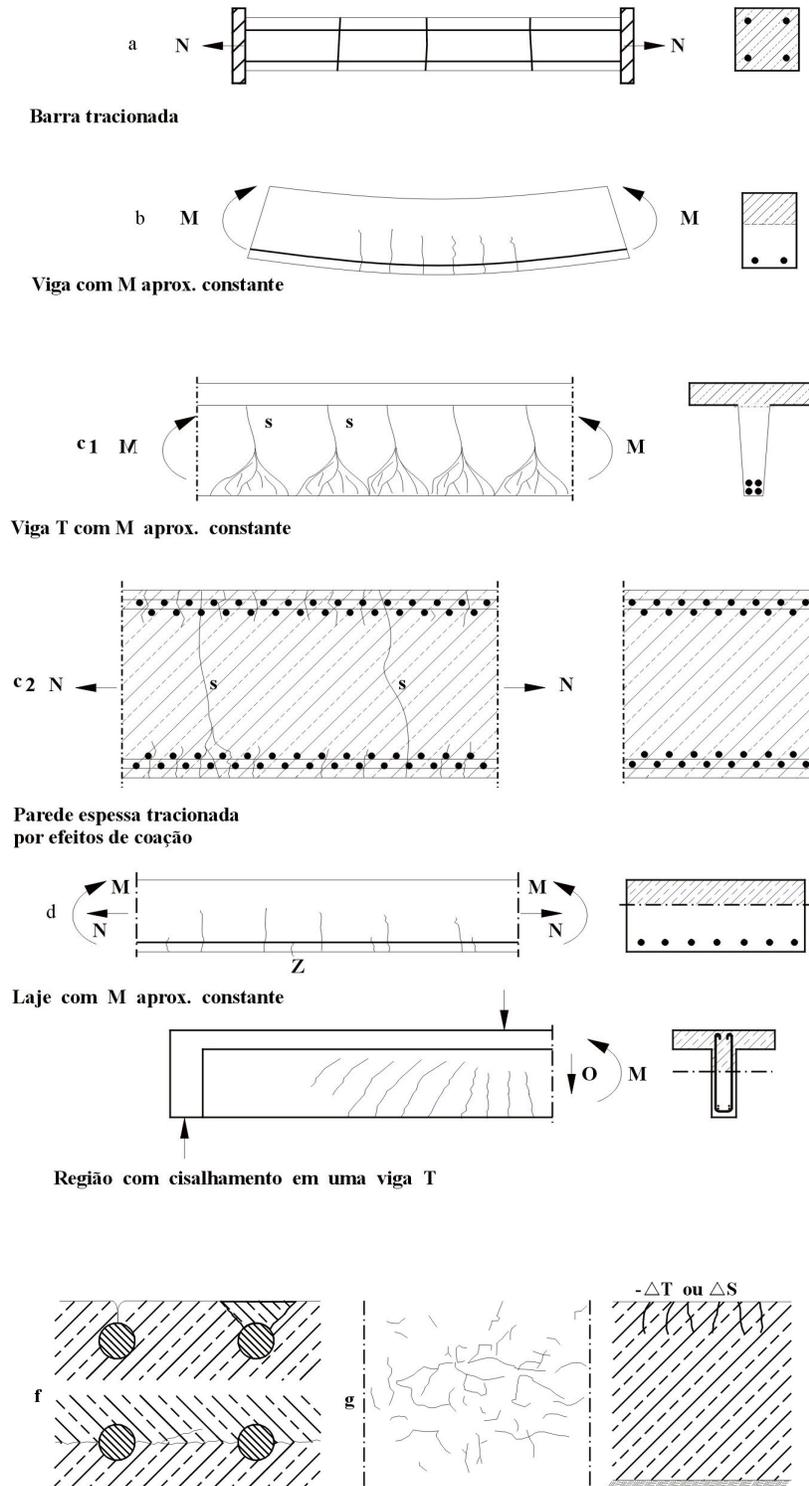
Tipos de fissuras segundo F. Leonhardt: a) fissuras de separação no caso de tração; b) fissuras de flexão; c) fissuras de convergência (S); d) fissuras intermediárias ou secundárias (Z); e) fissuras de cisalhamento; f) fissuras longitudinais ao longo das barras da armadura; g) fissuras superficiais ou rede.
